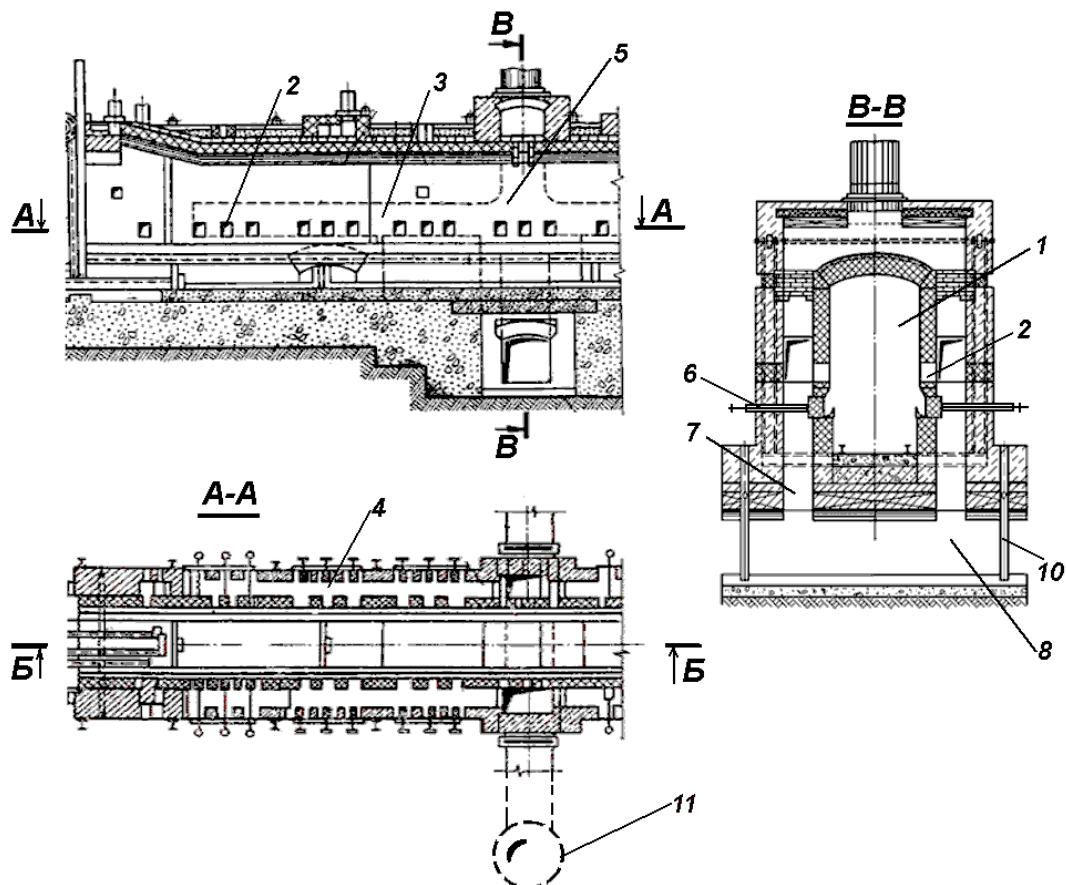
Схема отвода газов: I – продольный разрез; II – план; III – поперечный разрез
